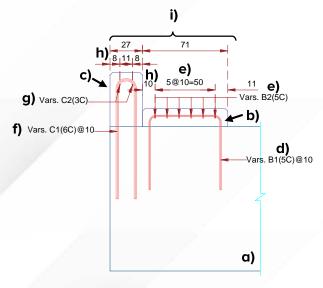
Ejemplo de planta del refuerzo de bancos y topes de pila
